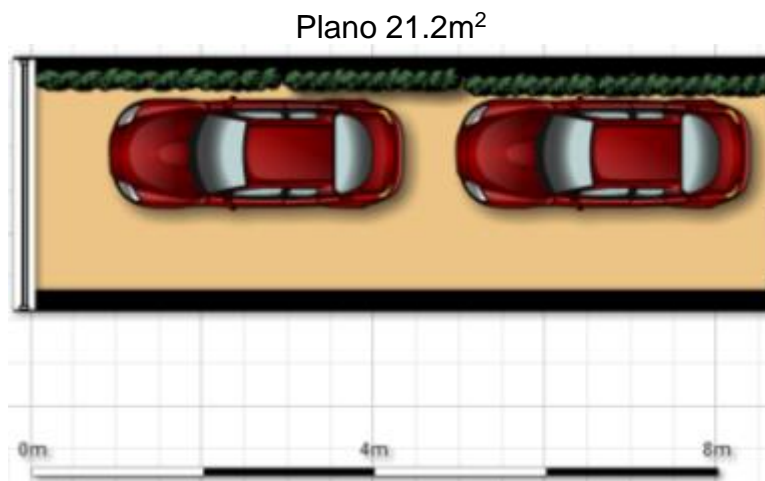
Plano de la planta baja actual del inmueble destinado para el centro de producción.
